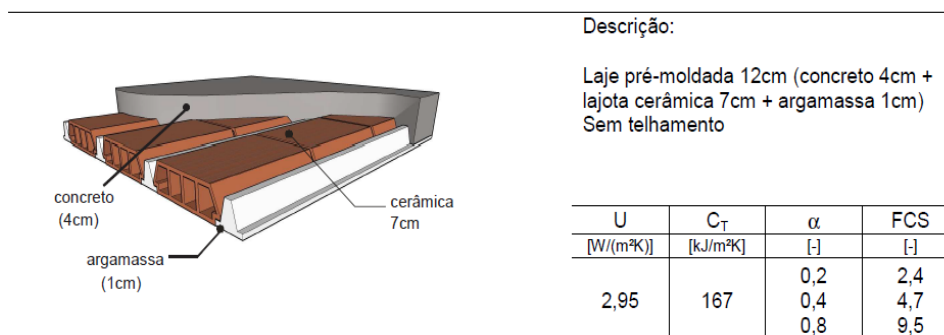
Configuração da cobertura. Fonte: LabEEE, 2011
